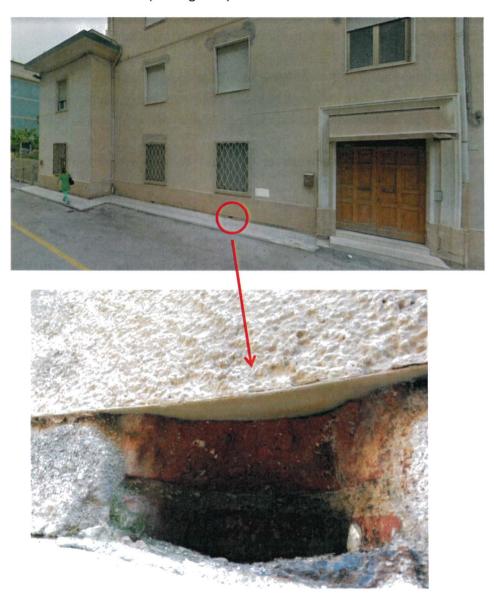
Il taglio delle murature con l'inserimento della guaina impermeabilizzante
